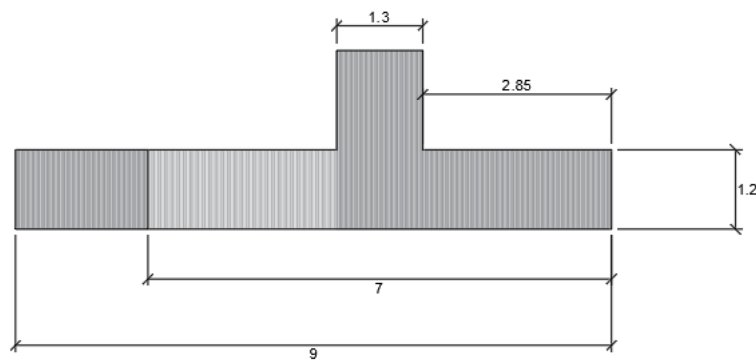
Alzado de la cimentación del Estribo Izquierdo.
